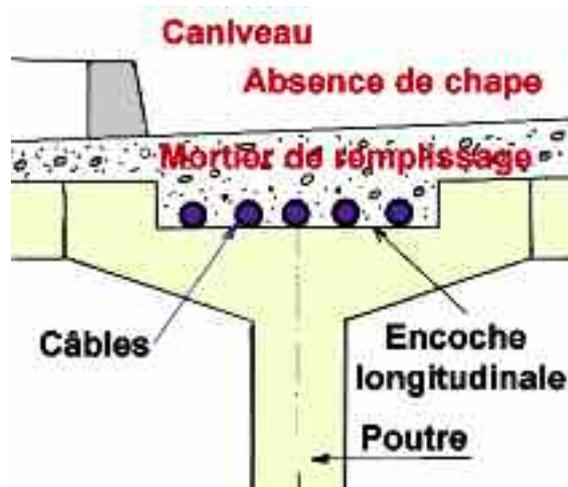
schéma de la disposition des câbles de précontrainte du pont d'Esquerchin
